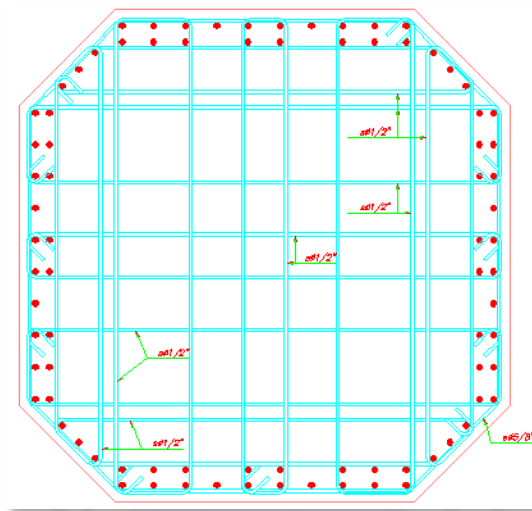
Pilares centrales con $84\phi 1''$ y 1 estribo $5/8''$ + 10 estribos $1/2''$
